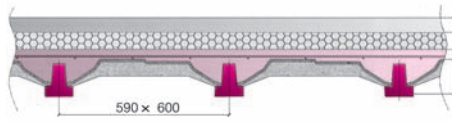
Plancher de type PSE DUO sur vide sanitaire
